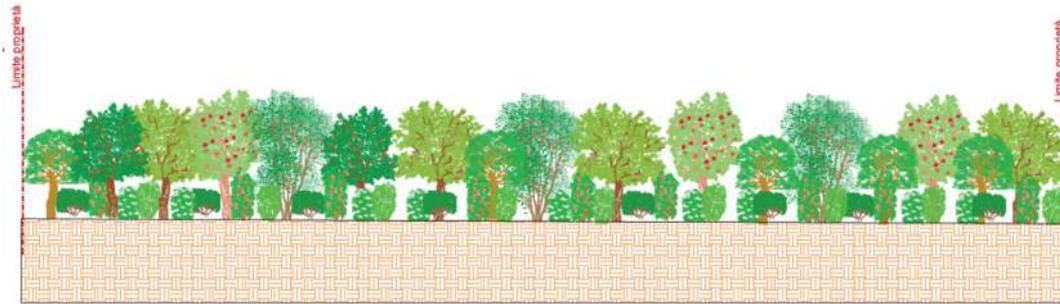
SEZIONE TIPO DELL'AREA BOSCATI IN PROGETTO
